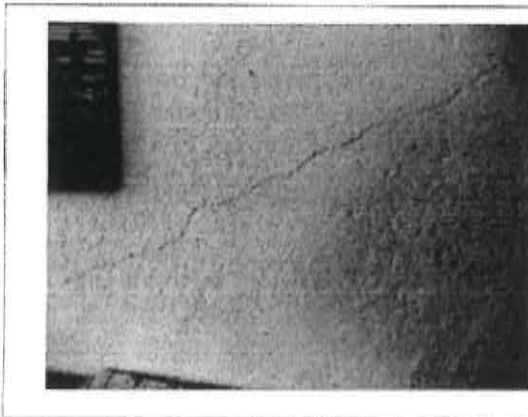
Fisura en muro divisorio "Cubiculo de investigadores"
